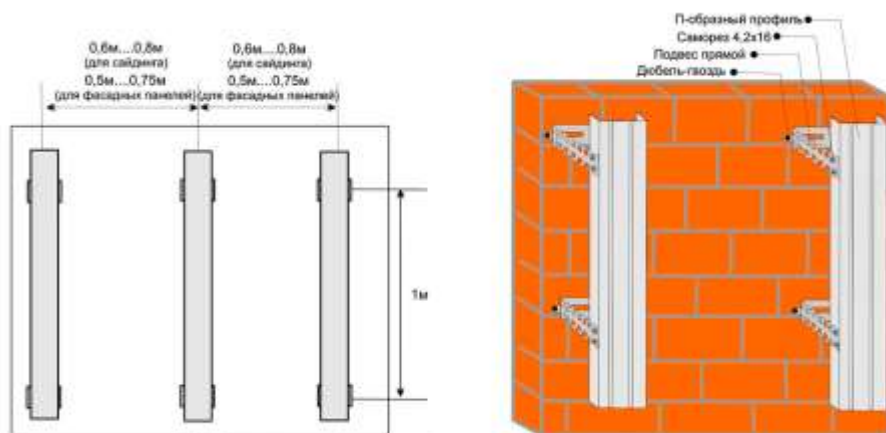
Горизонтальный монтаж сайдинга и фасадных панелей
